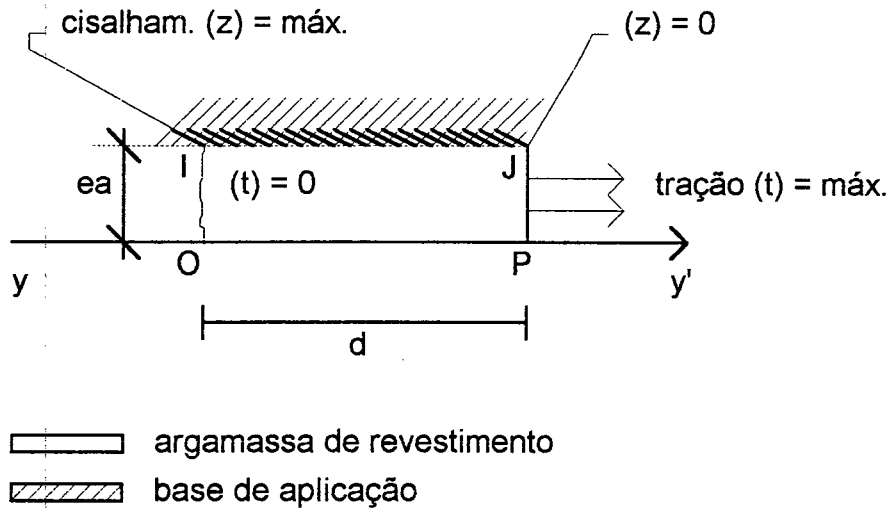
Princípio teórico de Joisel para equacionar o espaçamento entre fissuras por tração de um revestimento de argamassa JOISEL (1981).
